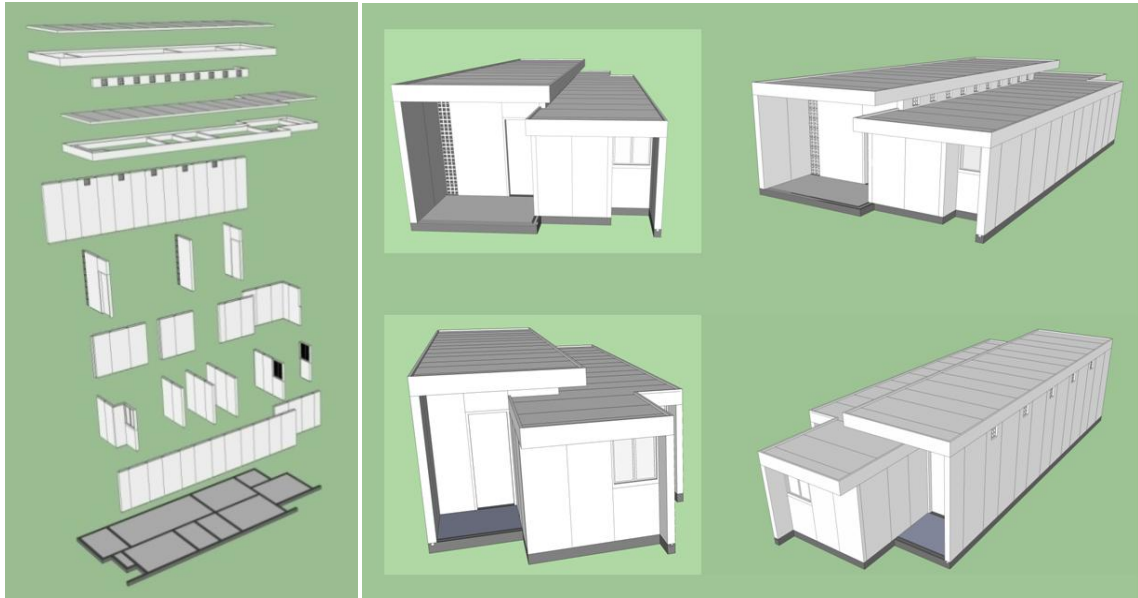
Sistema de montagem do Protótipo 02 com laje plana pré-fabricada em compósito cimentício.
